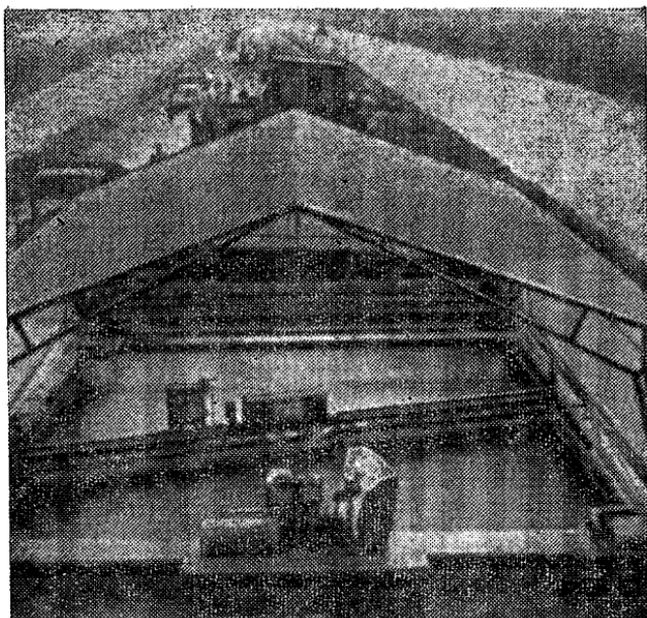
Передвижной шатровый навес для бетонирования дорожных покрытий
